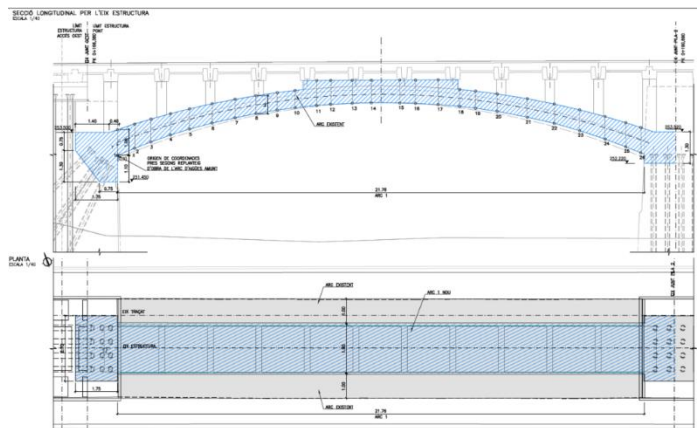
Elevação e plano do novo arco (fonte: Projeto de construção modificado)
